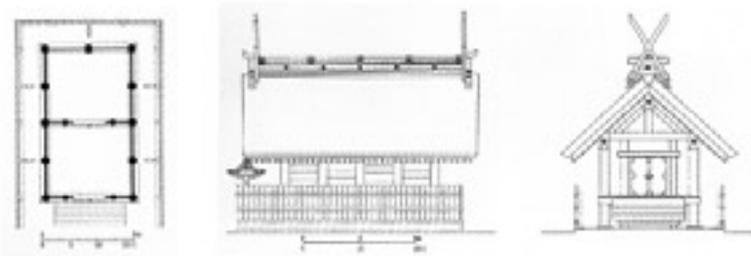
住吉大社本殿 平面図 側面図 正面図 『日本建築史図集』(日本建築学会編)
